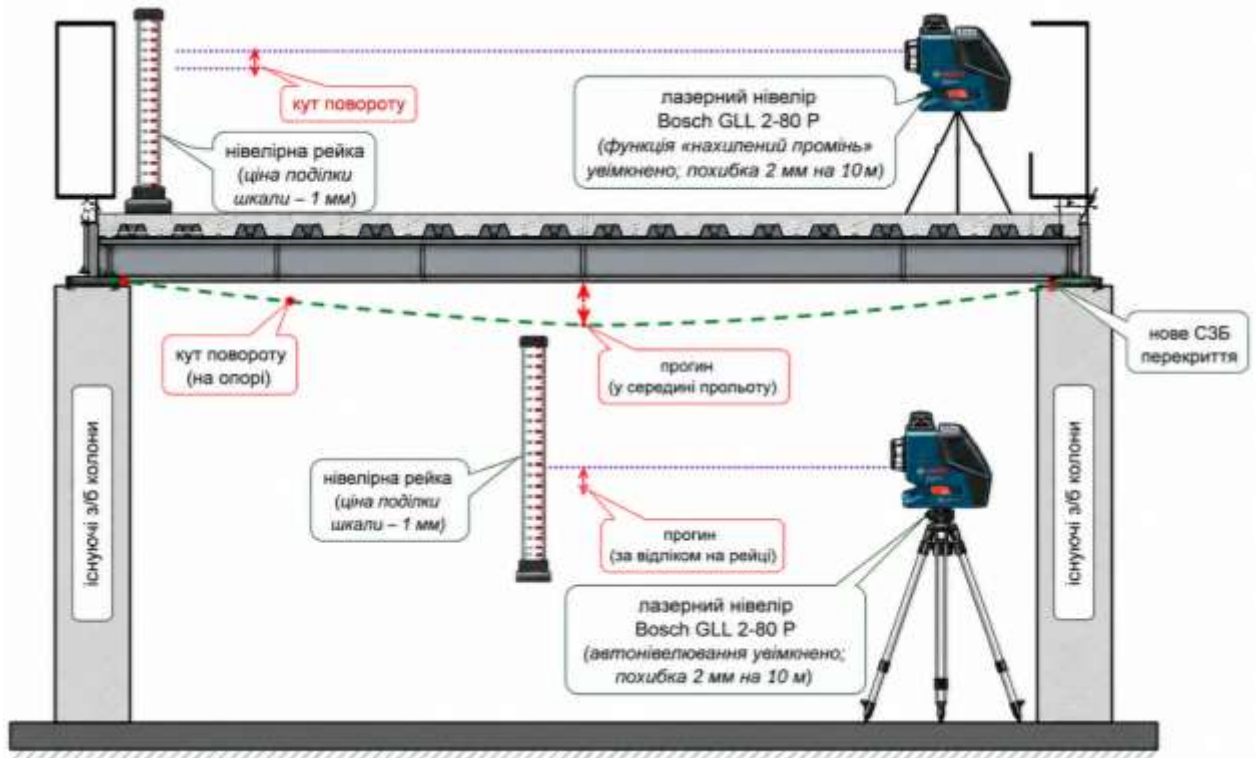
Схематичне розташування лазерного нівеліру Bosch GLL 2-80 Professional під час проведення натурного випробування ділянки вбудованого сталезалізобетонного перекриття
